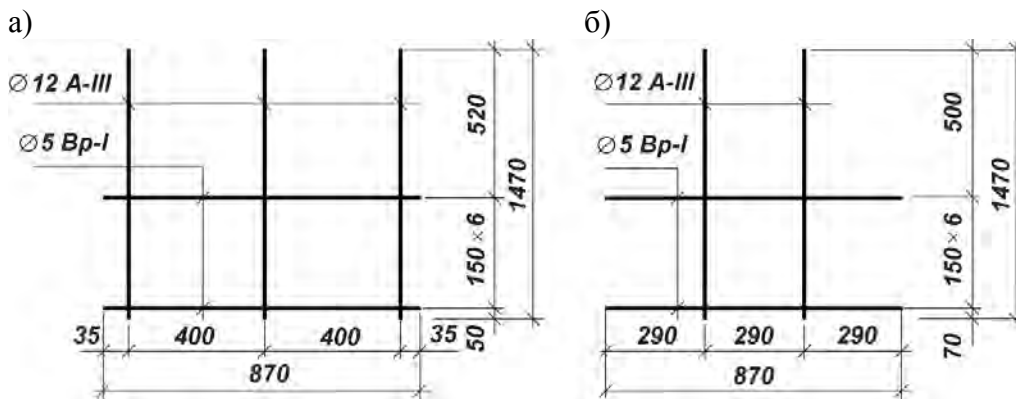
Продольное армирование подколонника плоскими каркасами:
